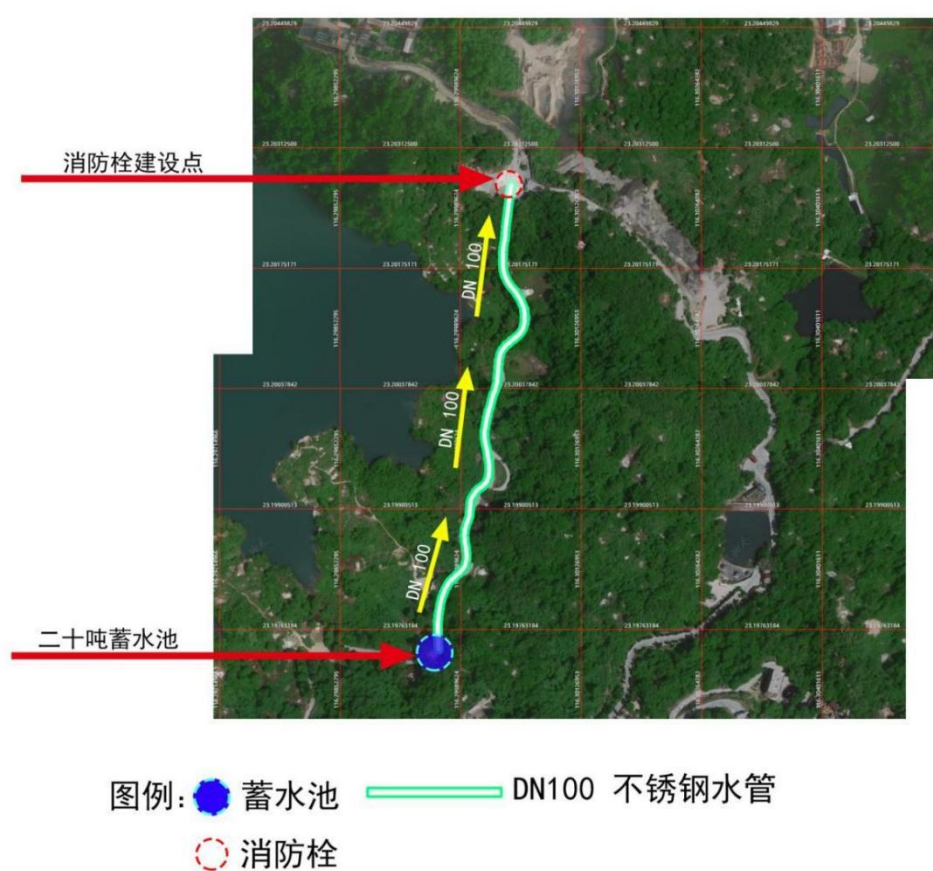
仙城镇长春村山建设点四规划设点平面图
